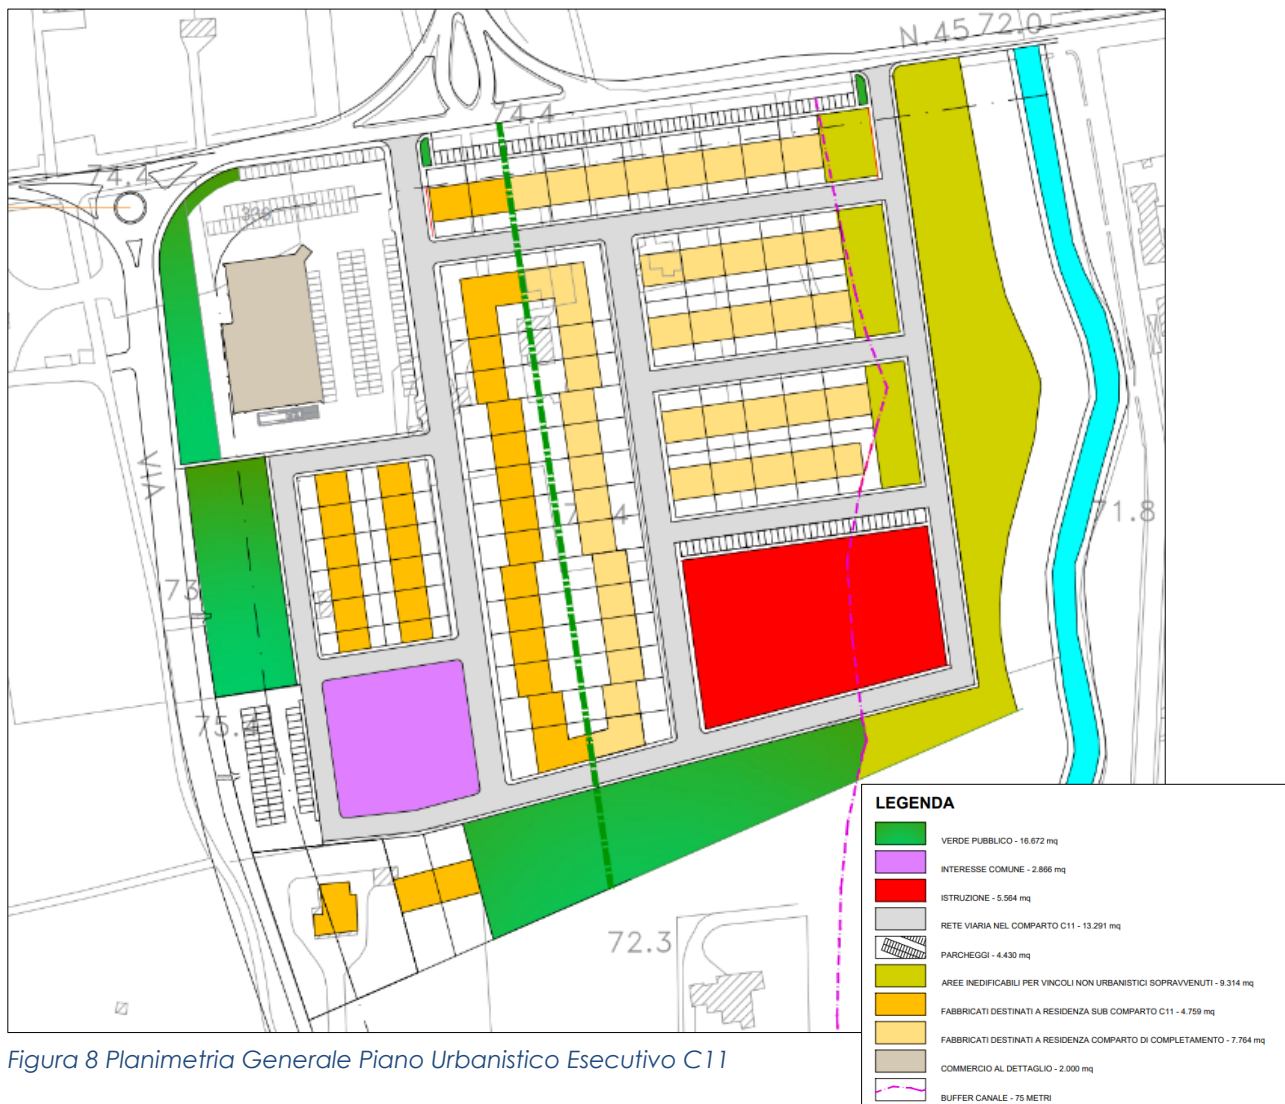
Planimetria Generale Piano Urbanistico Esecutivo C11
